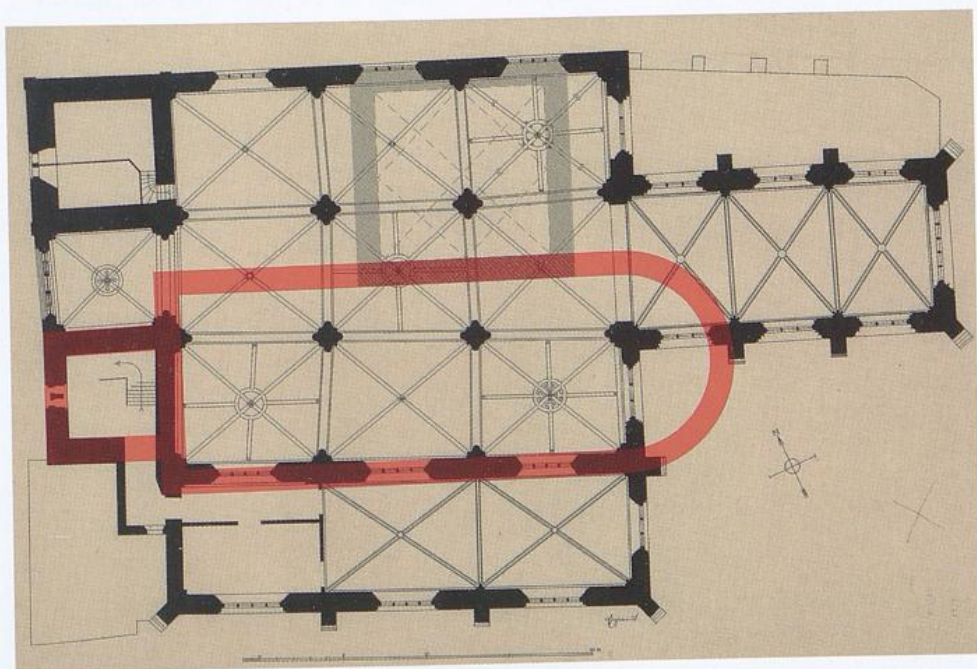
Unser Lieben Frauen, Grundriss Bau II um 1013/1029
